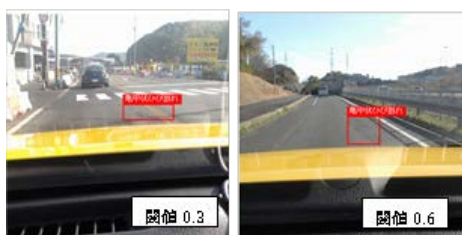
閾値による損傷取得事例 (ひび割れ)
